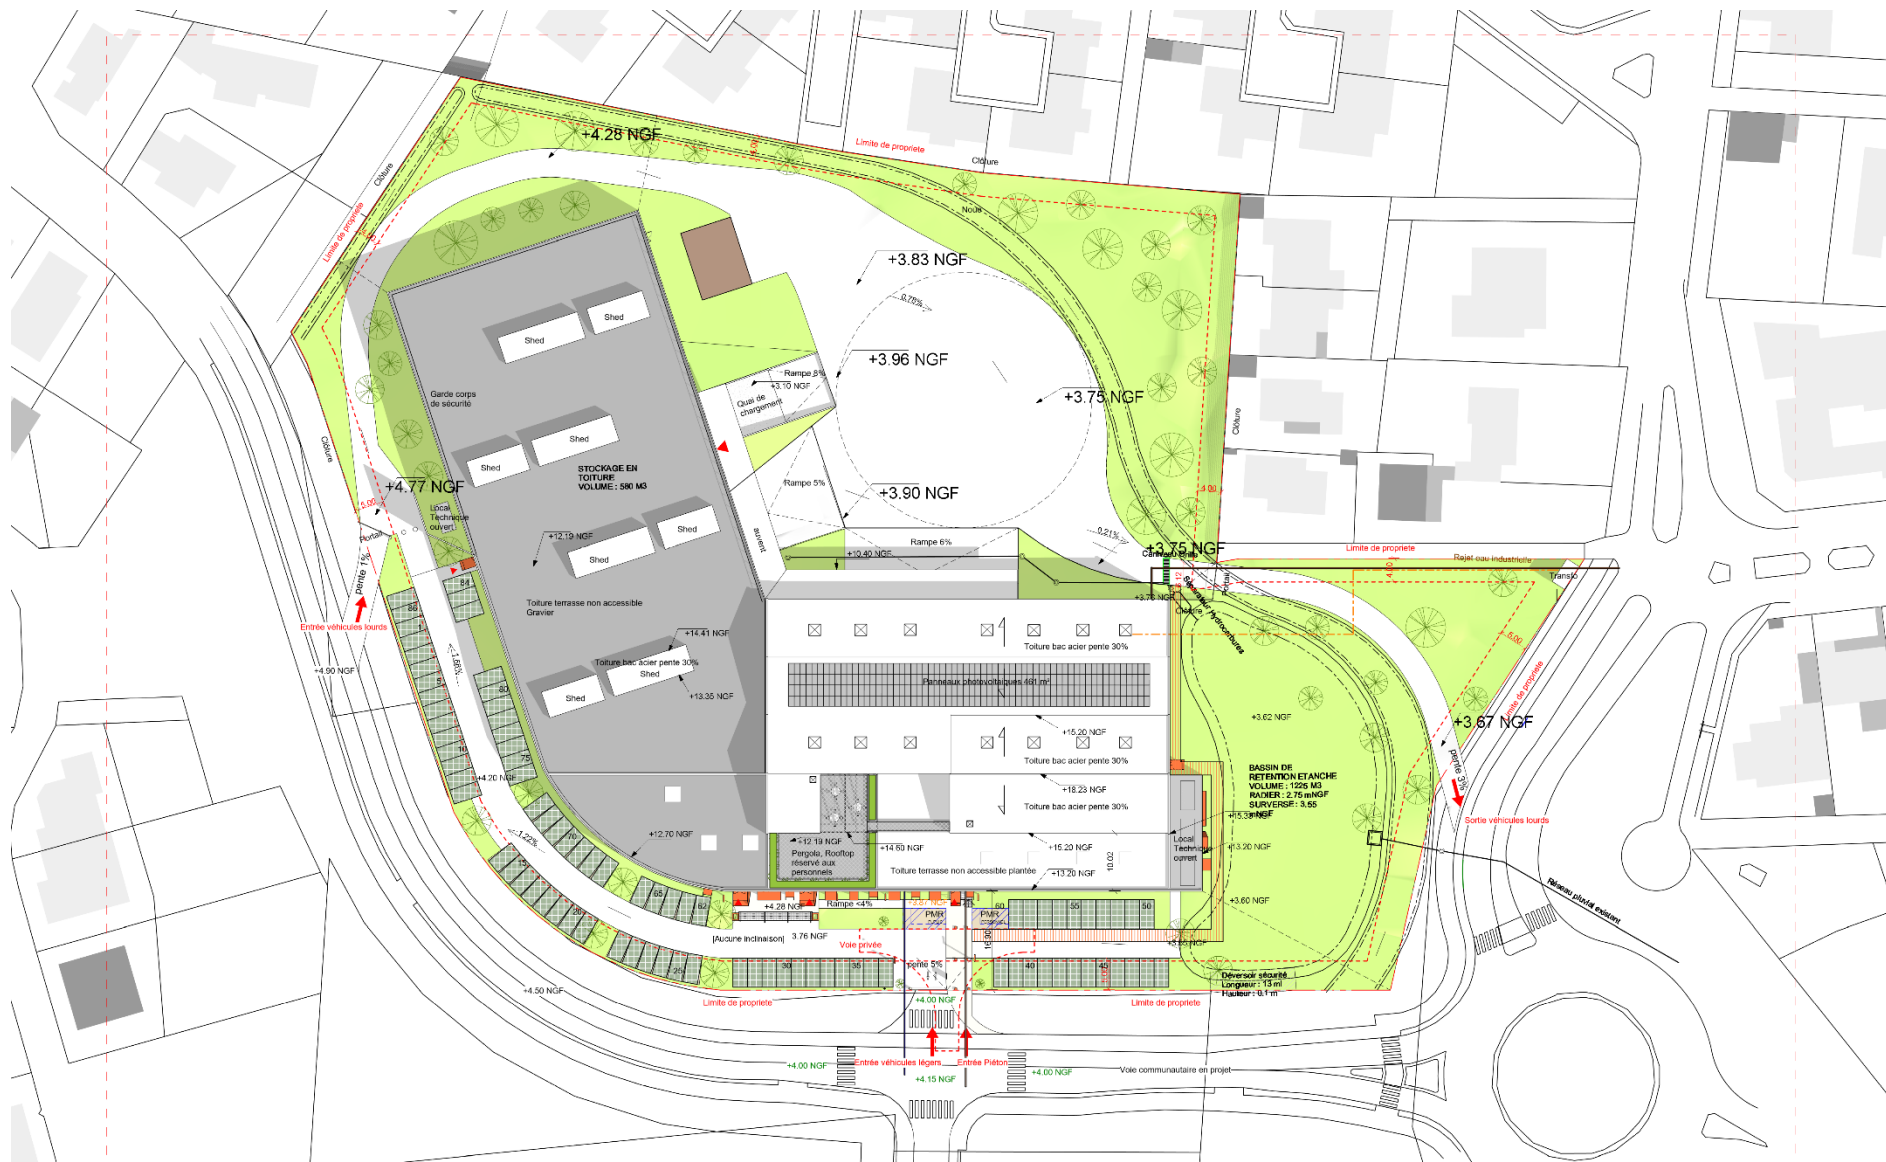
Plan de masse du projet de la cave Alma Cersius
